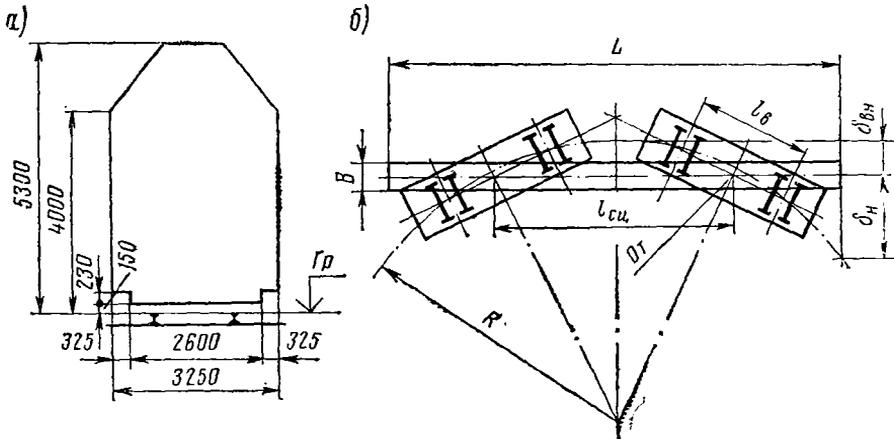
Схемы к определению предельных размеров грузов, перевозимых по железной дороге:
